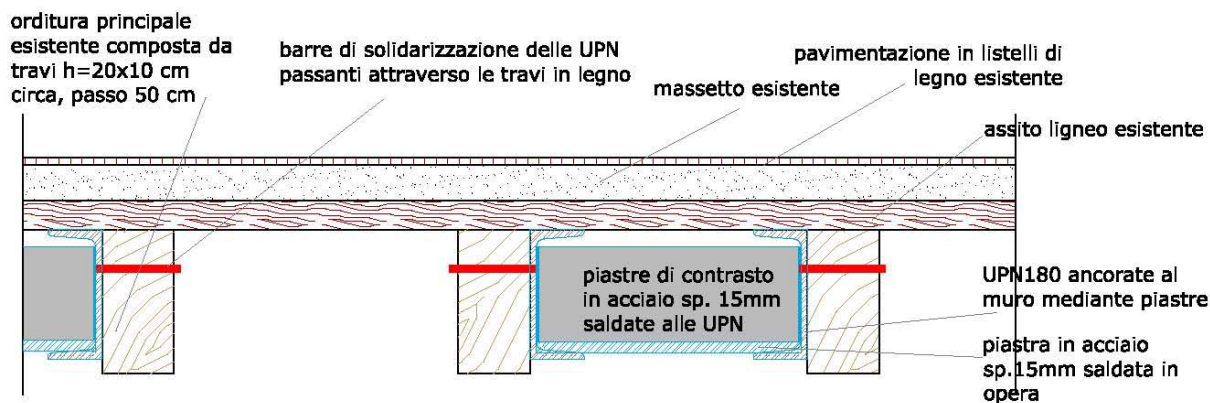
Particolare della sezione del piano primo: intervento di consolidamento intradossale mediante UPN 180.
